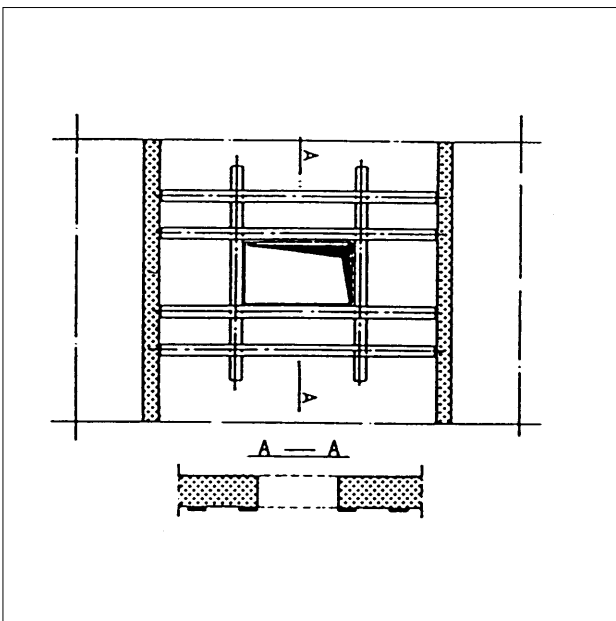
Dalle en béton/création d'une ouverture; renforcement au moyen d'une armature collée.
